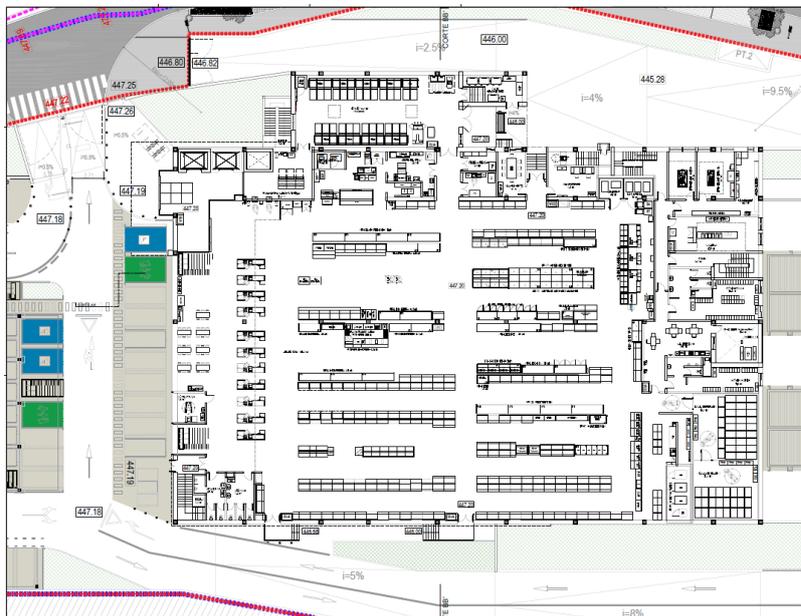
Layout* do piso térreo da Loja Mercadona (área de venda) (Fonte: EIA – Anexo II, junho 2023)
